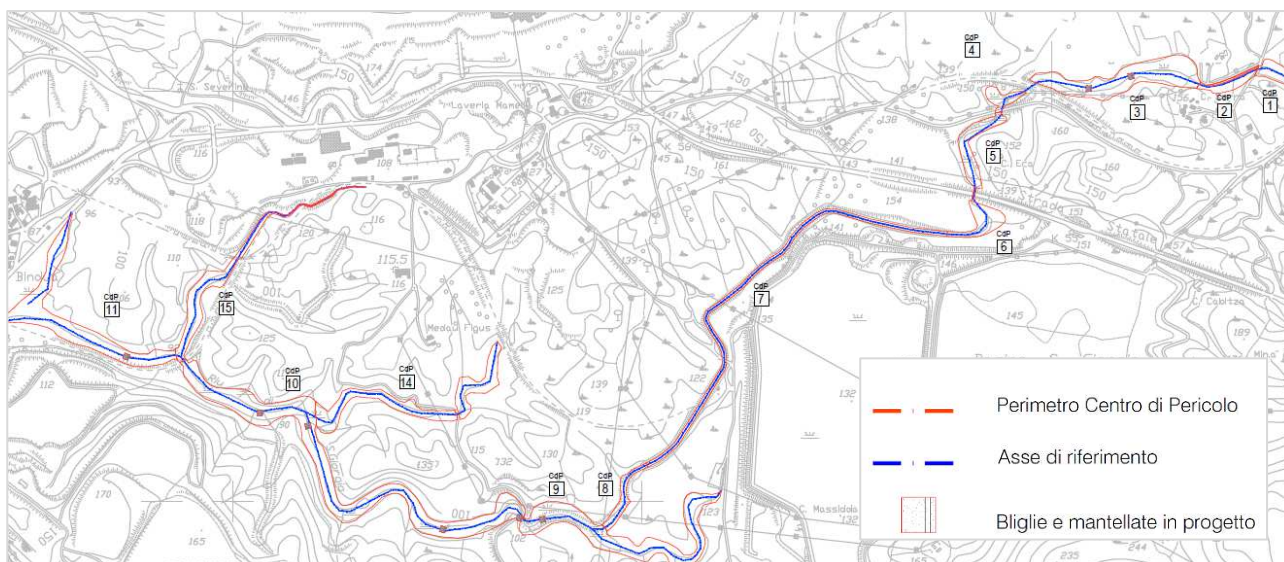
PLANIMETRIA INDIVIDUAZIONE DEI CENTRI DI PERICOLO E DELLE OPERE TRASVERSALI (BRIGLIE) PREVISTE NEL NUOVO PROGETTO DEFINITIVO
